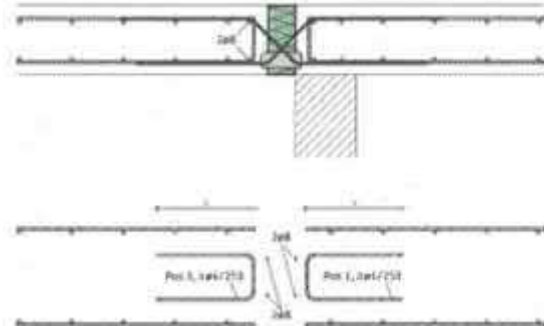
Bewehrungsführung QQ bei direkter Lagerung und deckenseitig geraden Querkraftstäben
